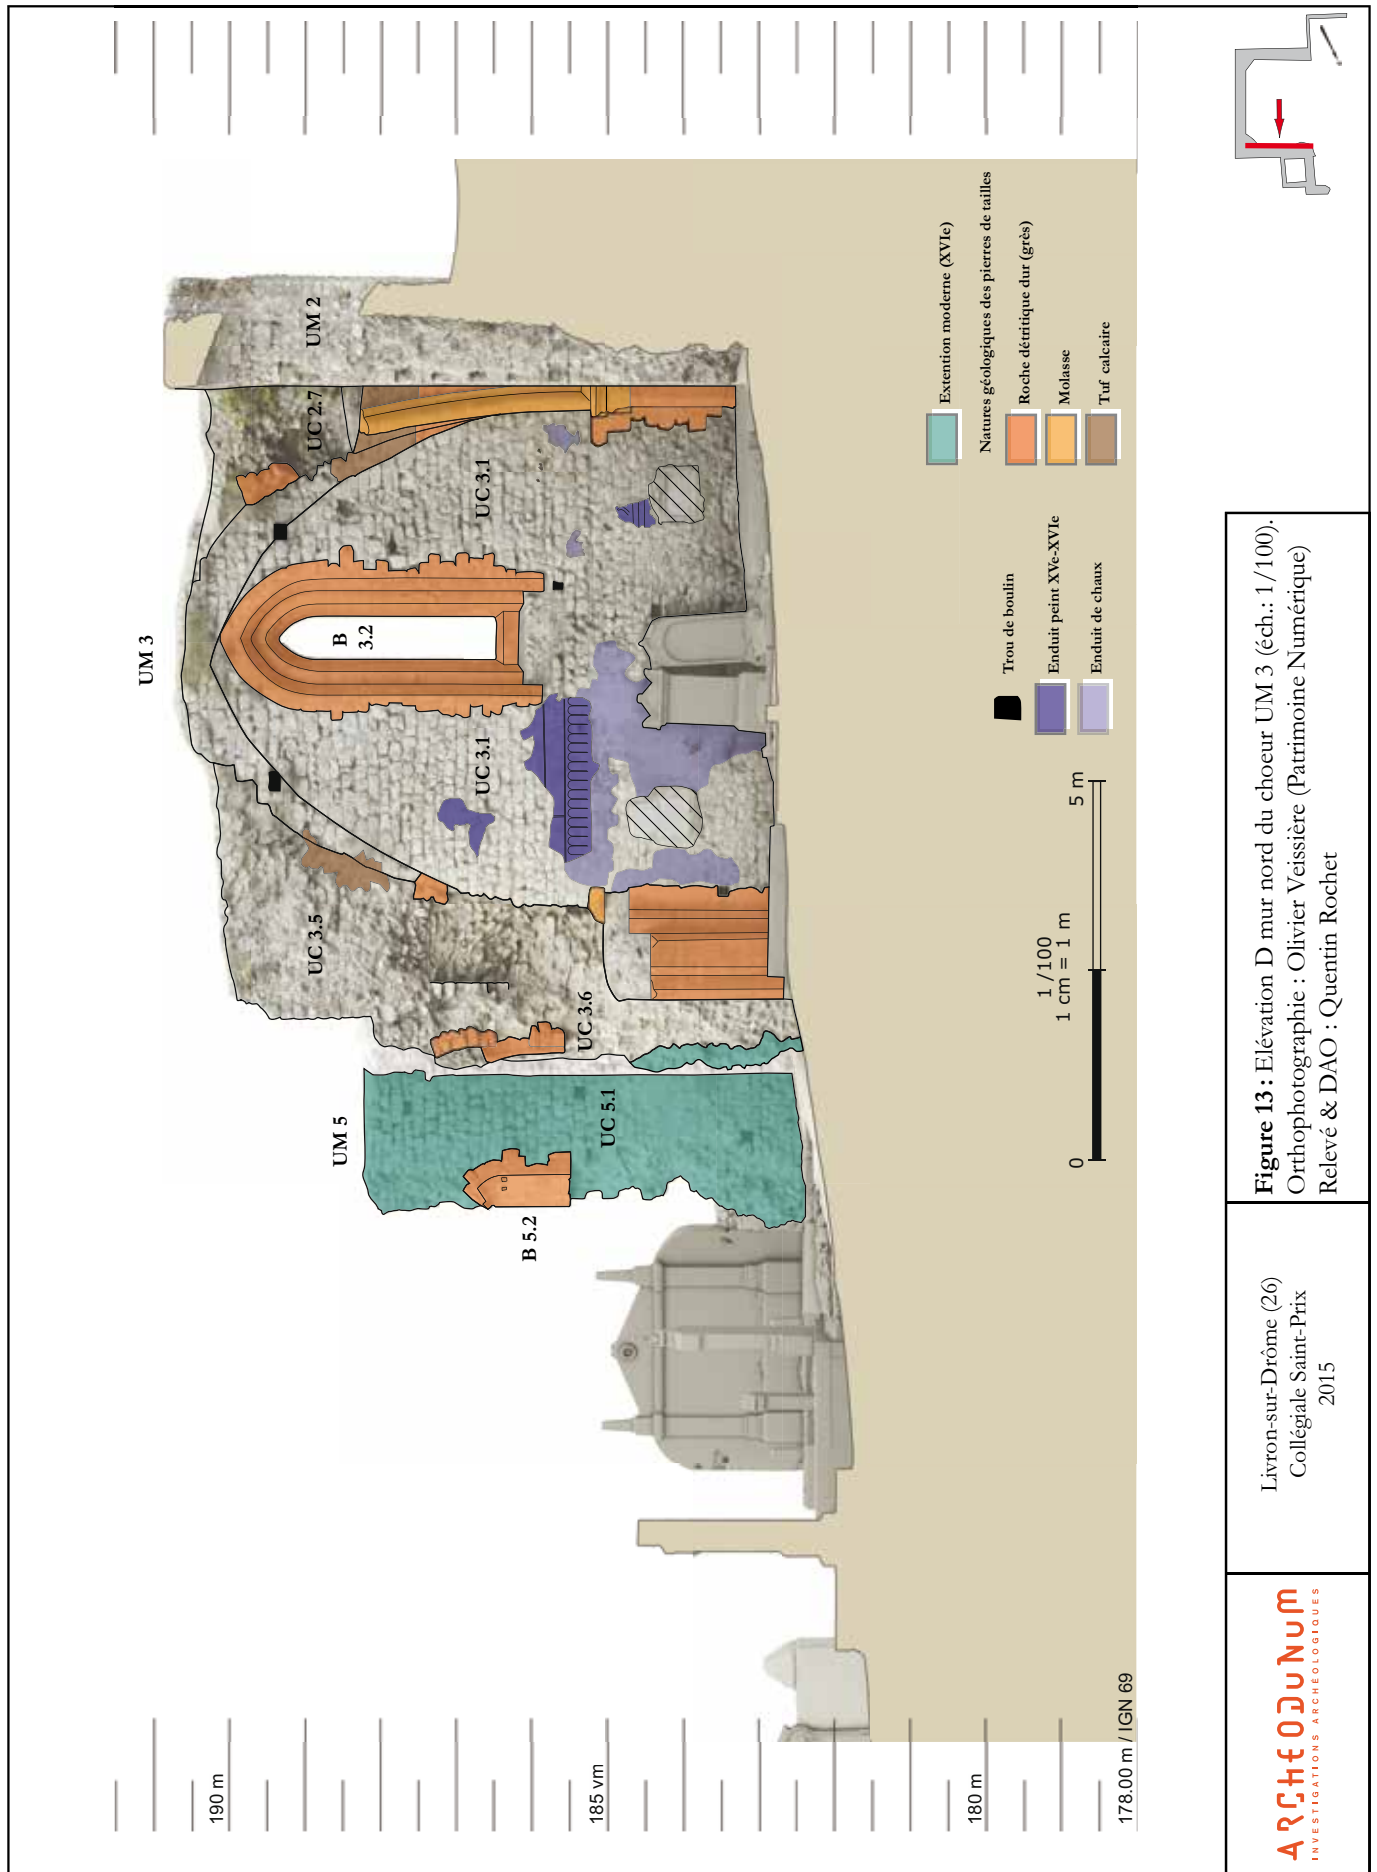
Elévation D mur nord du chœur UM 3 (éch.: 1/100).
